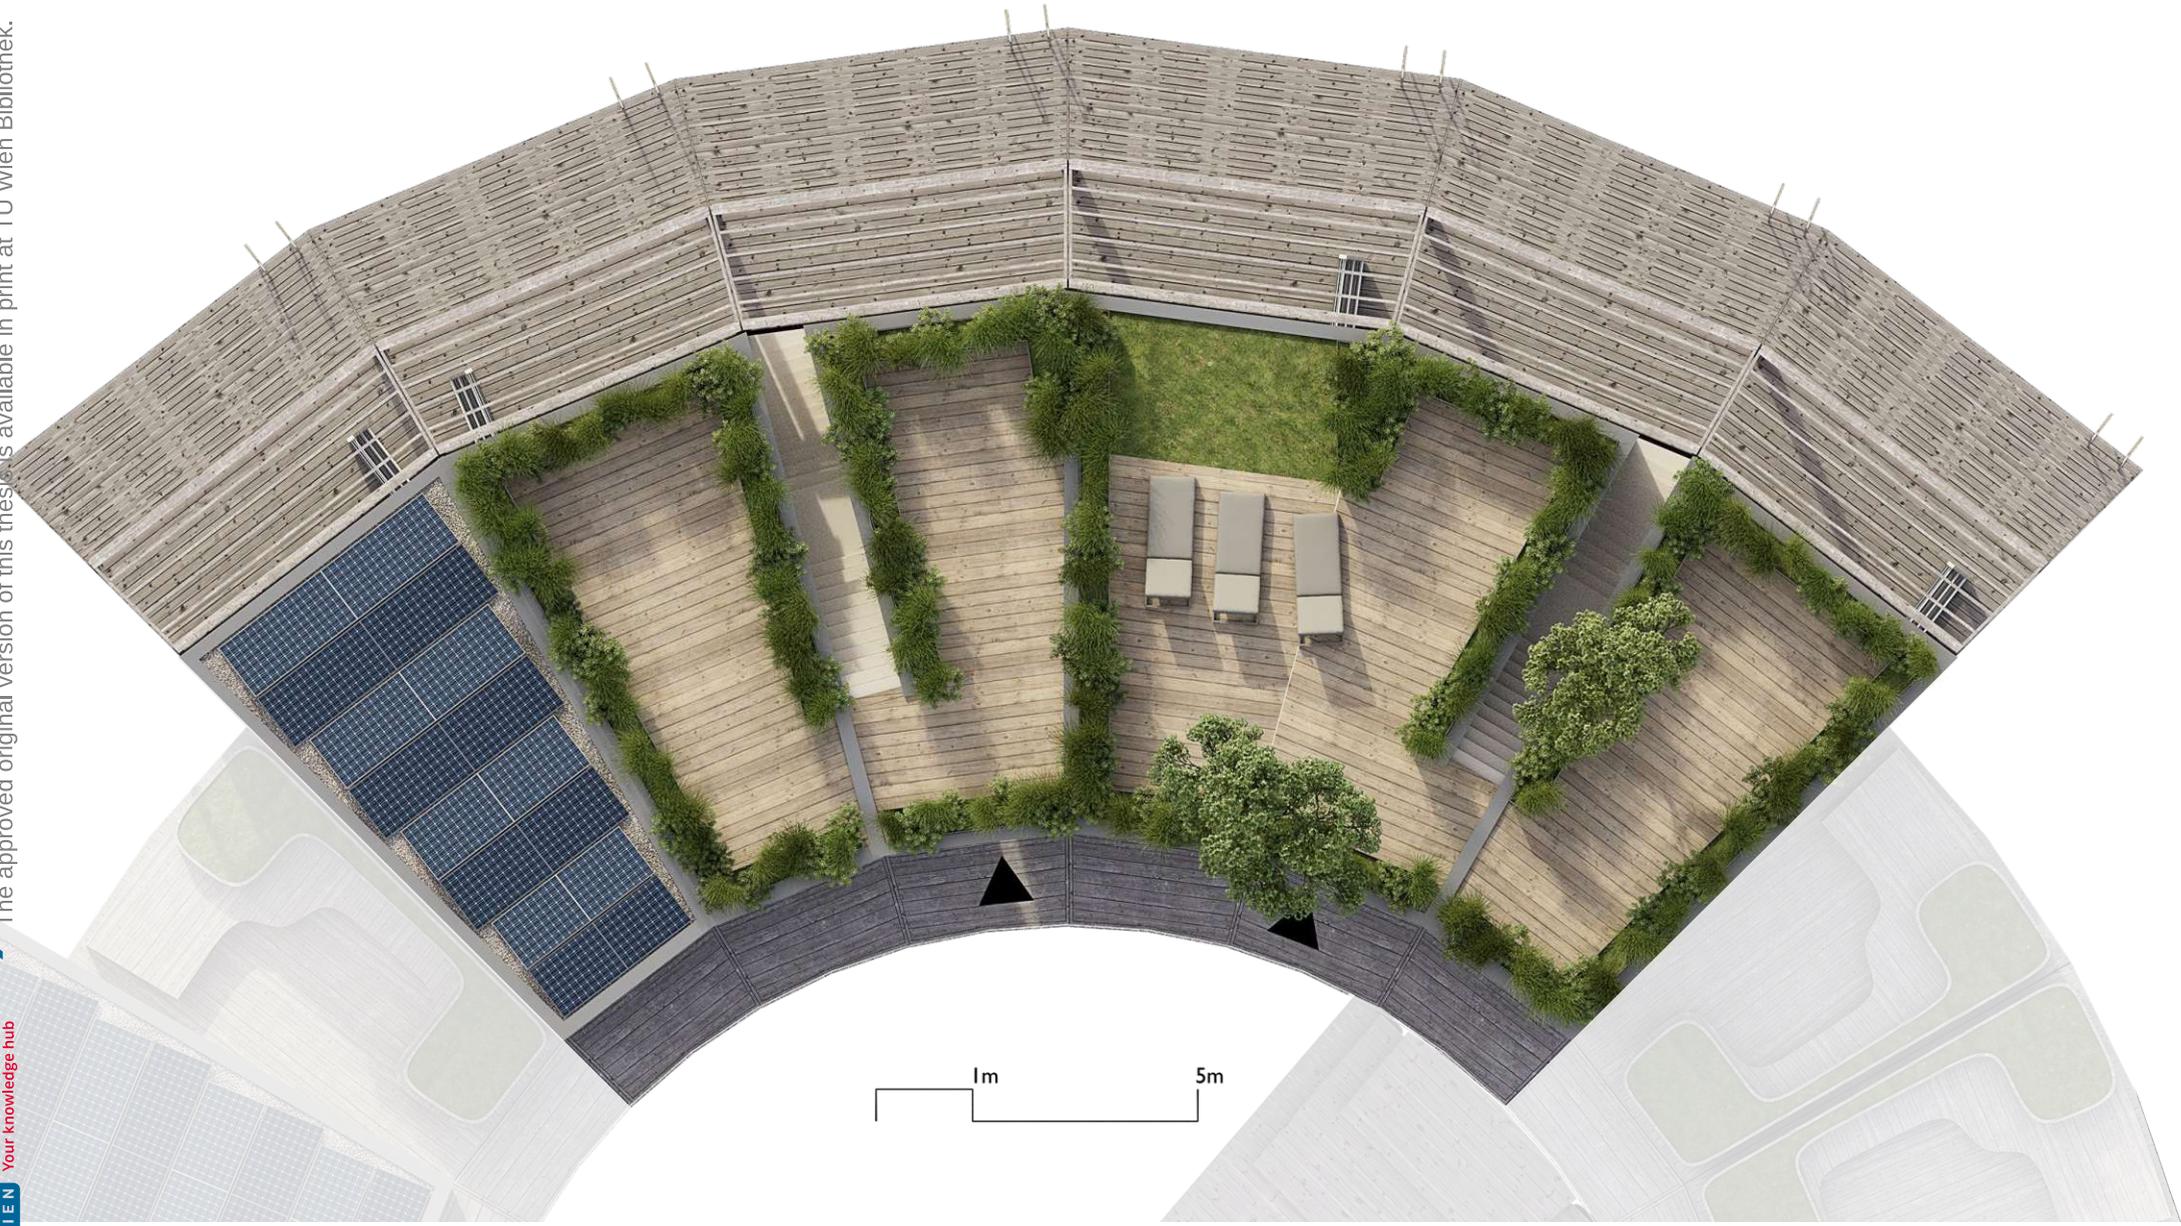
Grundriss-Variante D- Office (180m²)- Dachterrasse (von J.C. Aurel)
